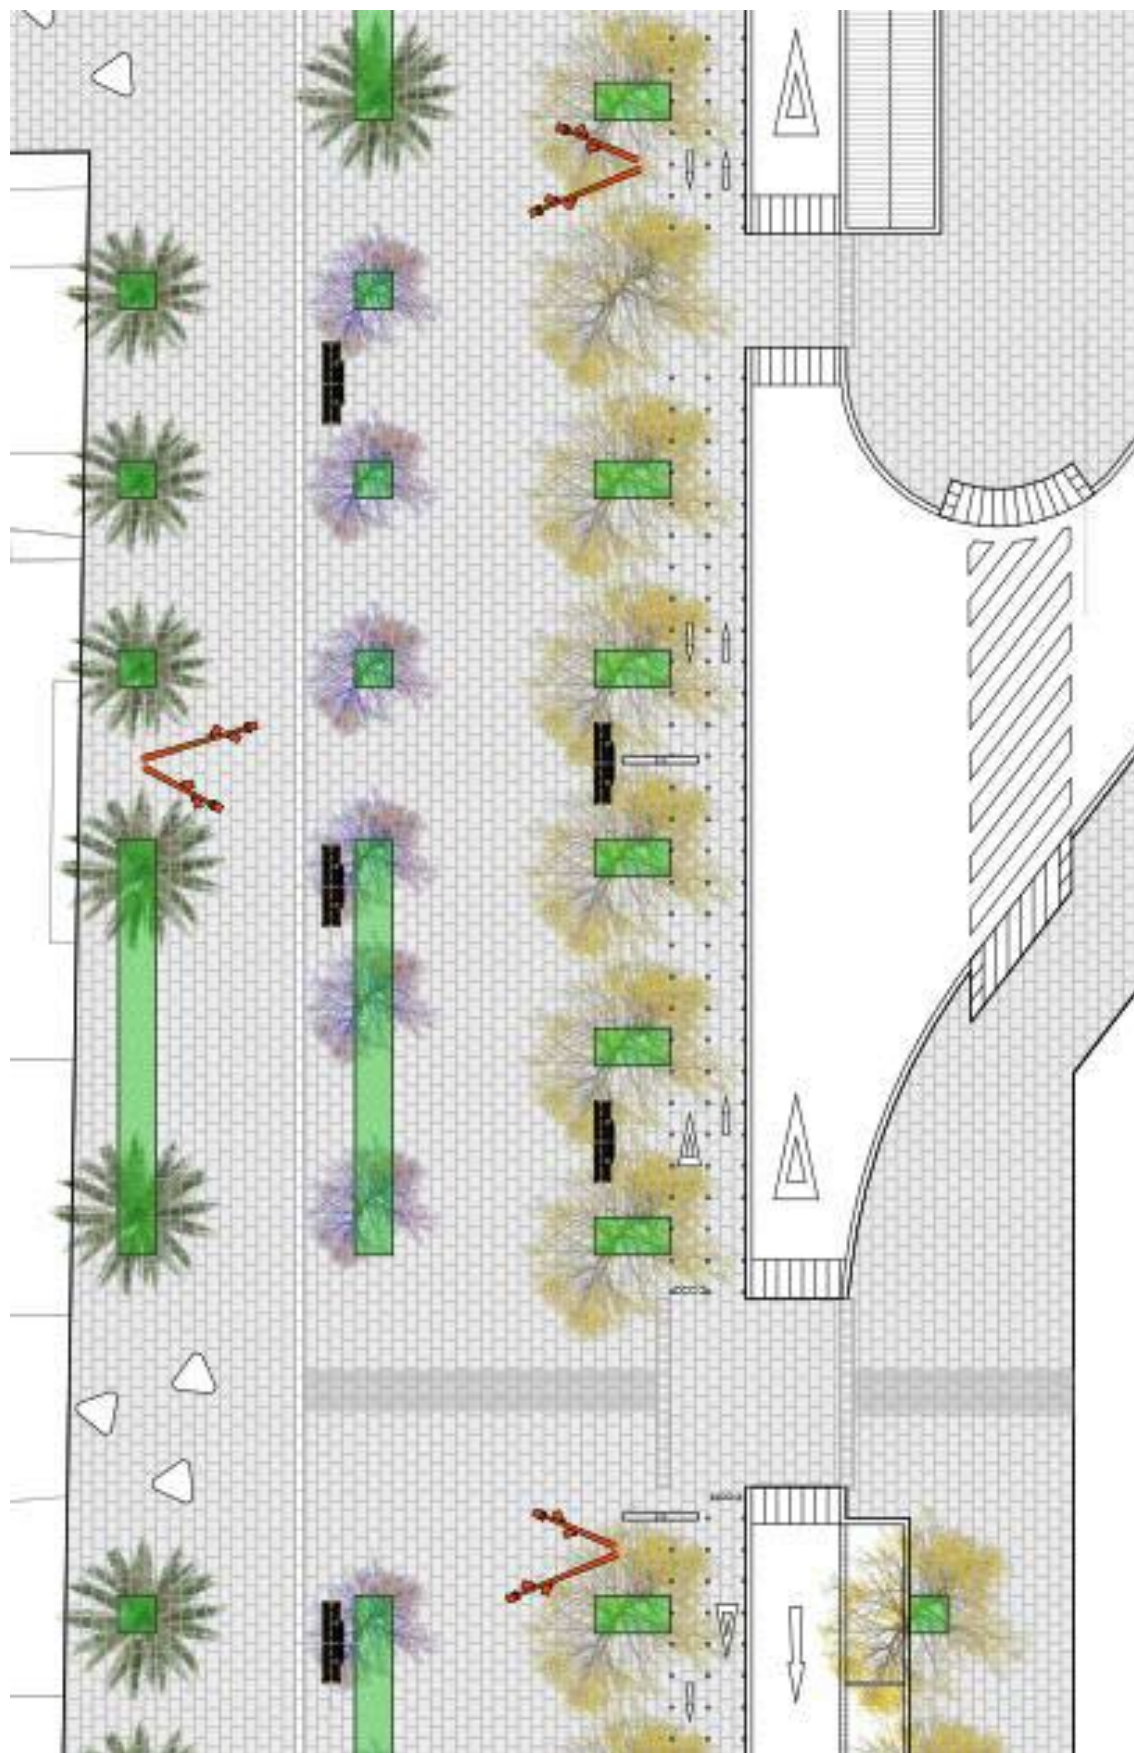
Planta de la propuesta para la calle dels Cresques que incluye un aparcamiento subterráneo
